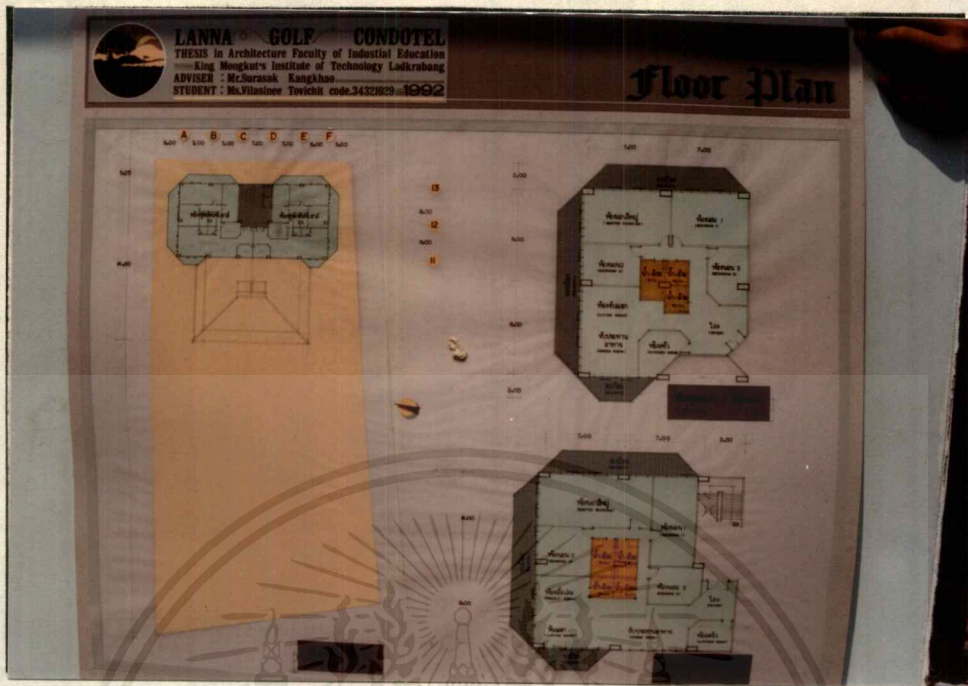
, ผังพื้น (FLOOR PLAN)
